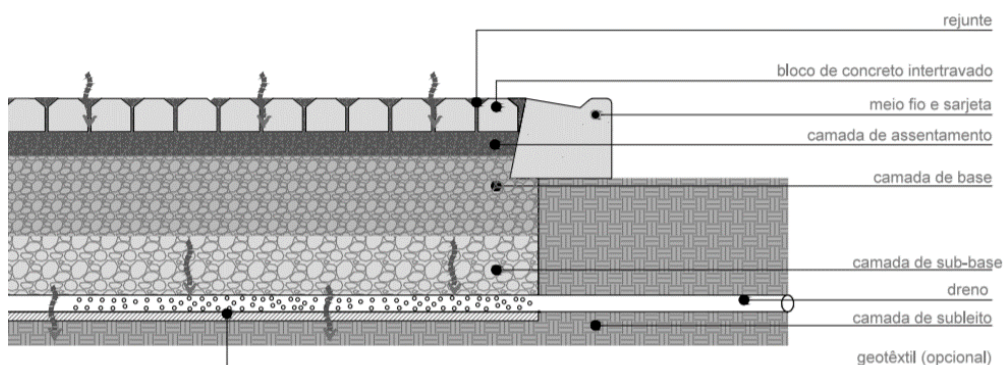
Pavimento intertravado permeável com infiltração parcial no solo ([ABCP, 2015](#)).
